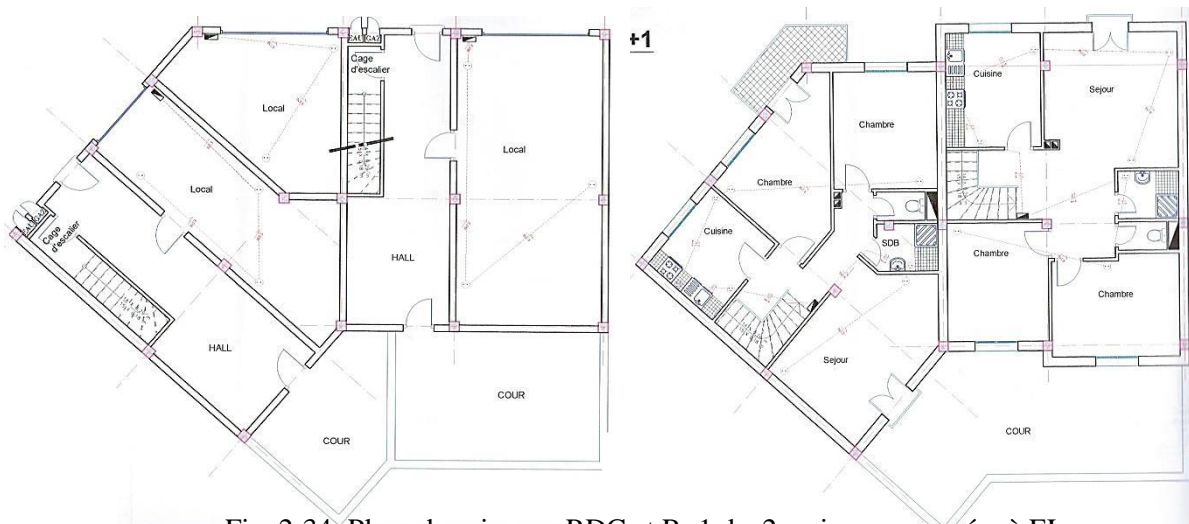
Plans des niveaux RDC et R+1 de 2 maisons groupées à EL KERMA, Opération 66 logements LSP. Source : DUC d'Oran
